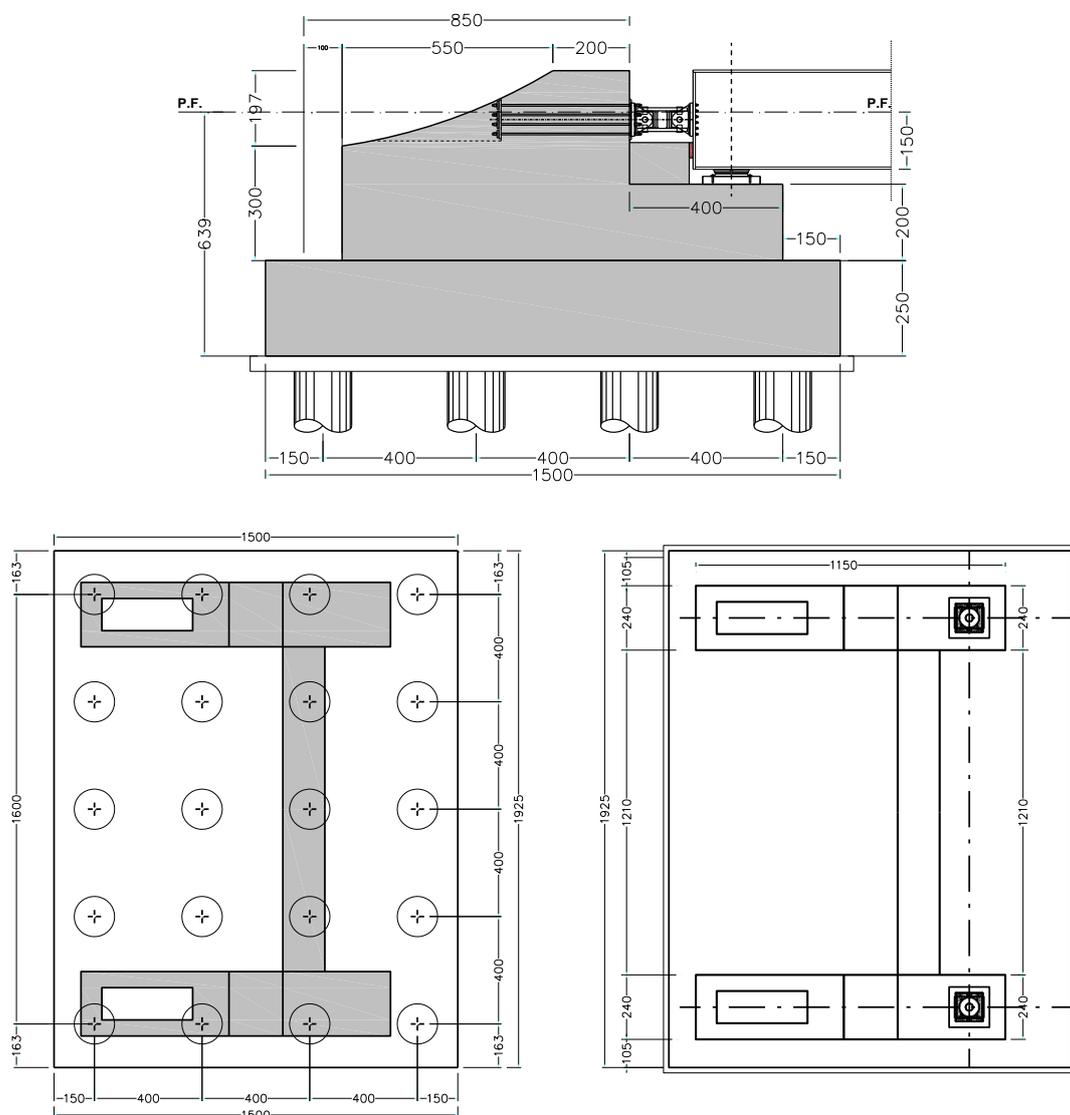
Prospetto e piante della spalla fissa
